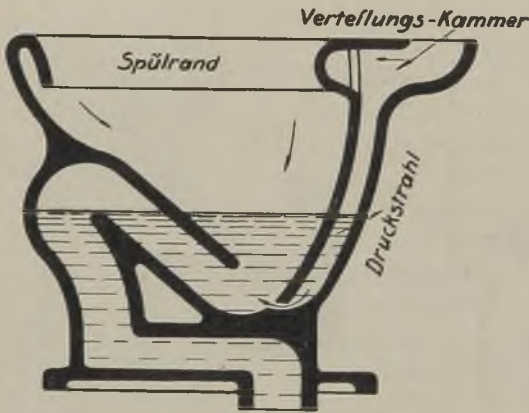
Druckstrahl-Absaugklosett mit innenliegendem Abgang hinten — mit gerader Rückwand — Einlauf von hinten für 2" Einlaufverschraubung.
